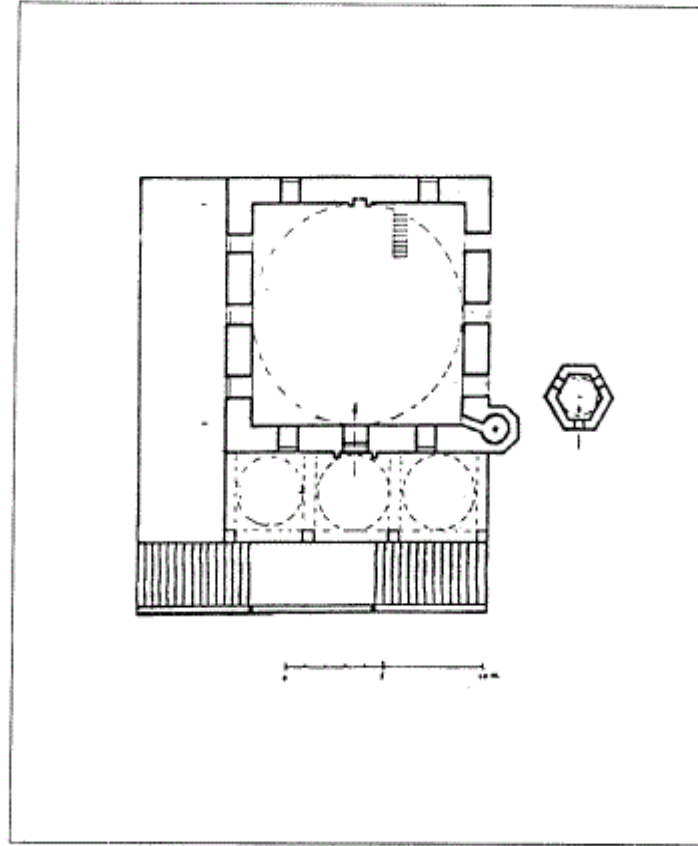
مسقط أفقي لمسجد قبر شنلو في ببرات (عن : كيل) .
